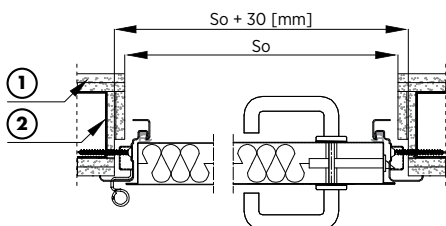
Montage mural d'un bloc-porte à un battant avec bâti angulaire - coupe horizontale
